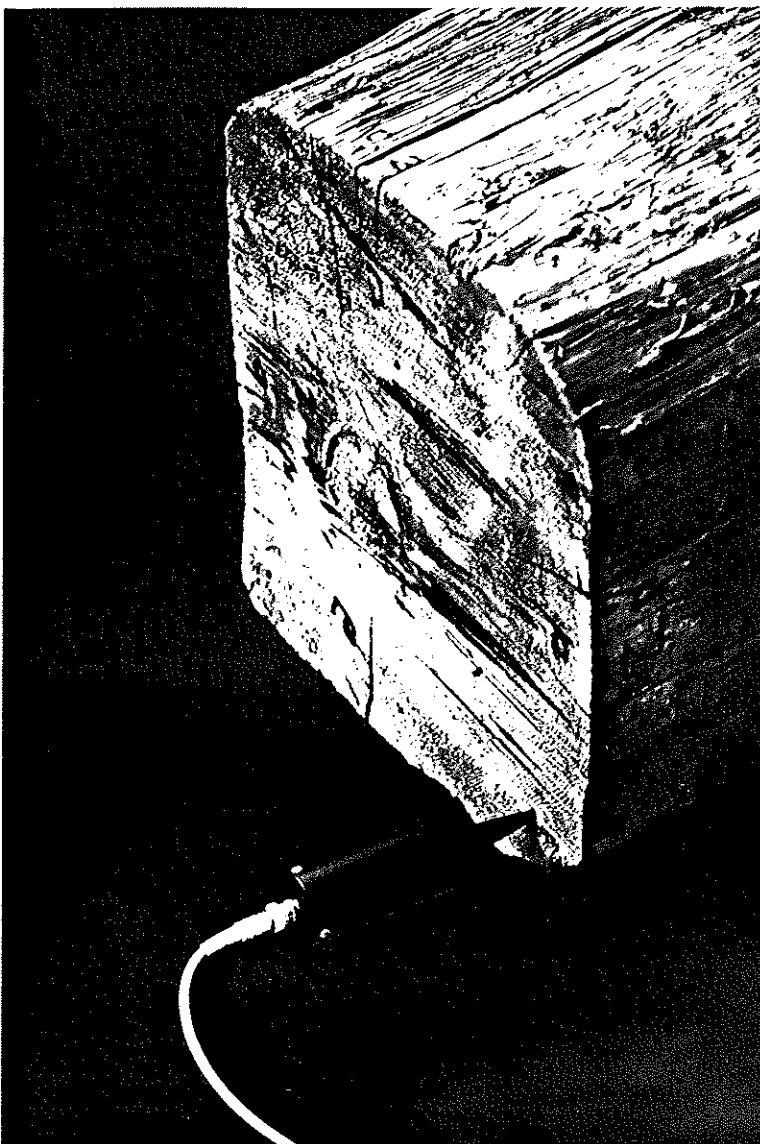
Posizione delle sonde del SYLVATEST rispetto alle testate delle travi nelle prove con una inclinazione di 0° rispetto alla direzione della fibratura ($v_{i,0}$, $E_{us,0}$)
